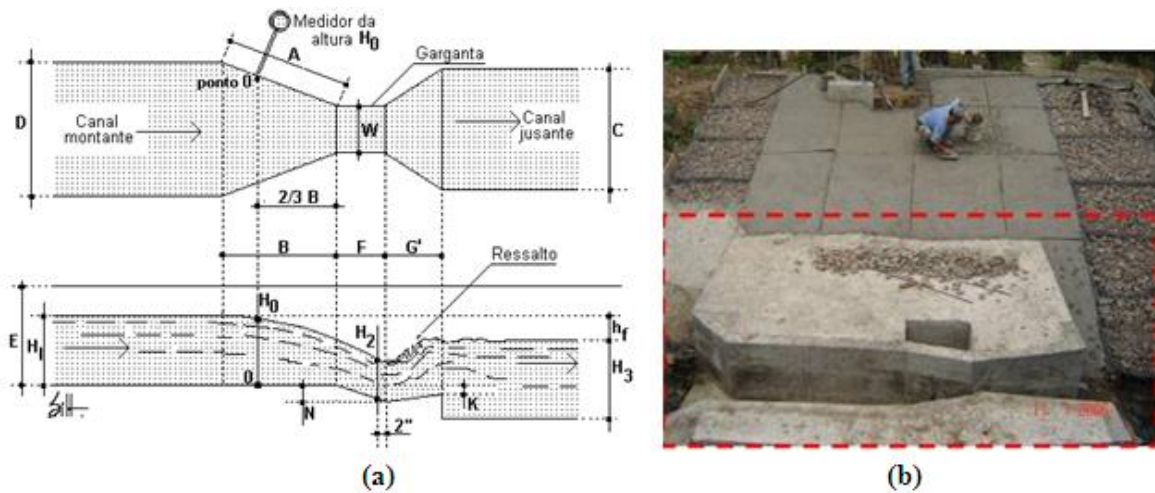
(a) Planta baixa de uma típica Calha Parshall. (b) Calha Parshall utilizada para monitoramento na bacia escola urbana (Adaptado de Silveira, 2007).
